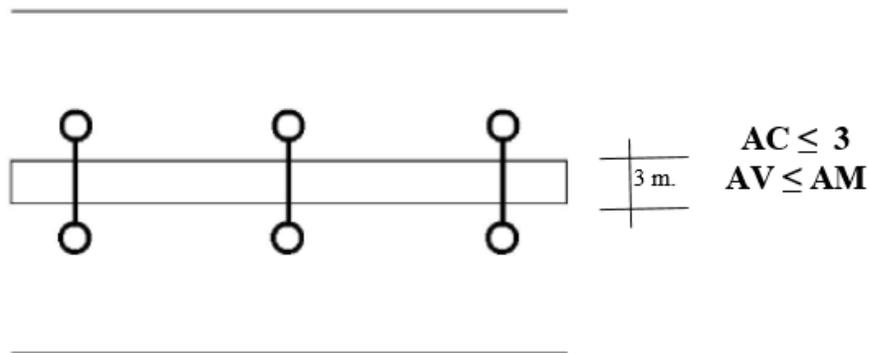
Disposición de las luminarias en camellón con brazo doble.
